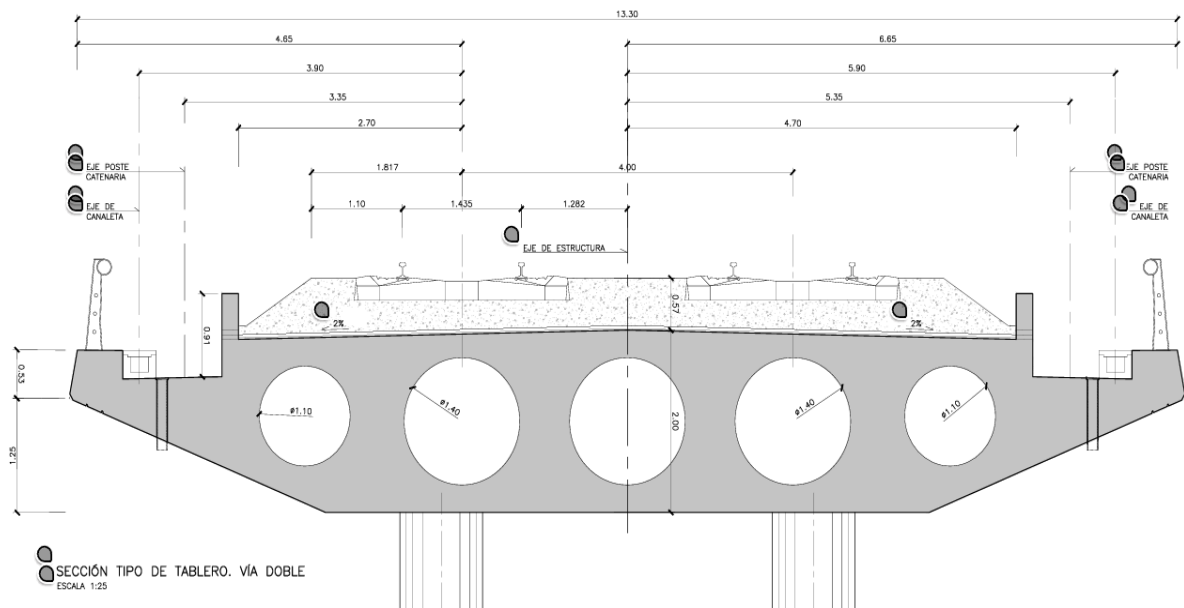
Sección de viaducto para sistema de metro tren ligero elevado.
